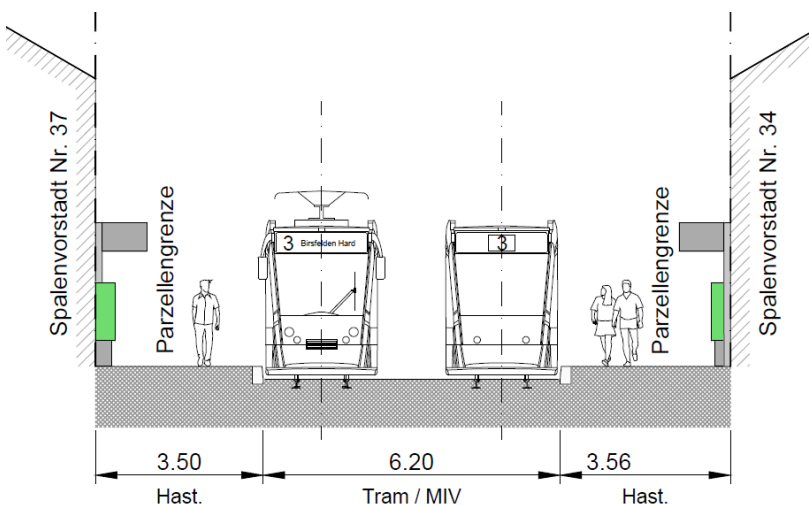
Strassenquerschnitt mit zukünftiger Haltestelle Spalentor (Blick stadtauswärts)
